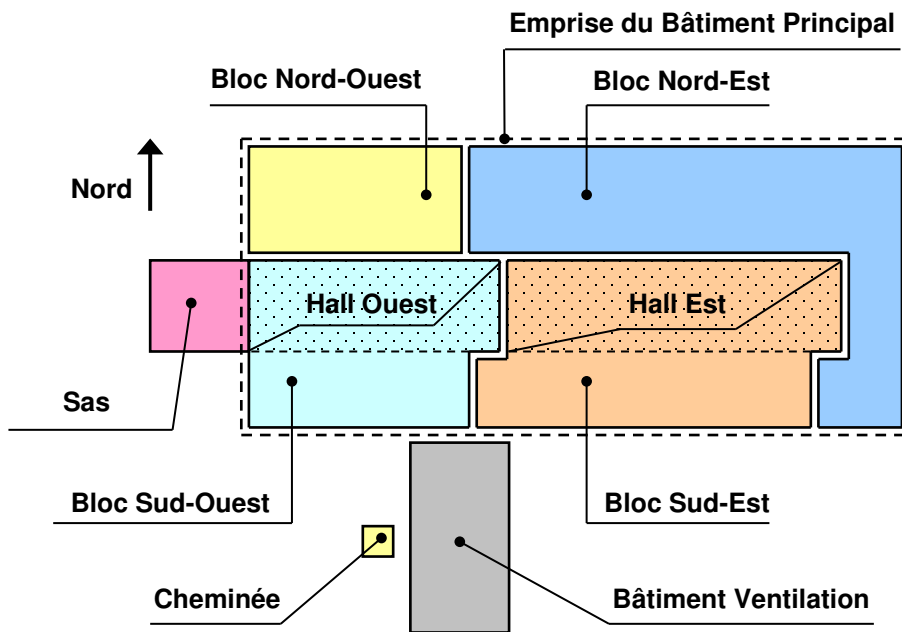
vue en plan du Bâtiment Principal et des autres ouvrages voisins
